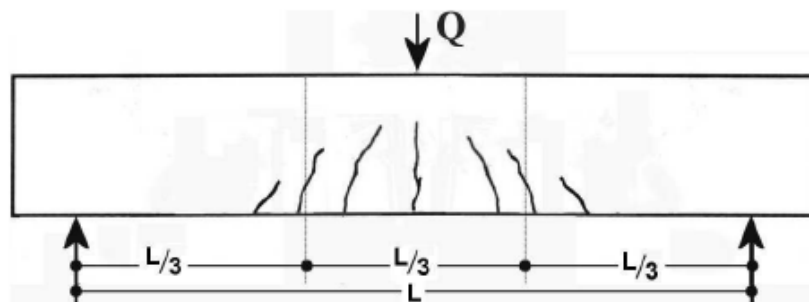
Schéma typique d'une poutre en béton armé endommagée par flexion.
